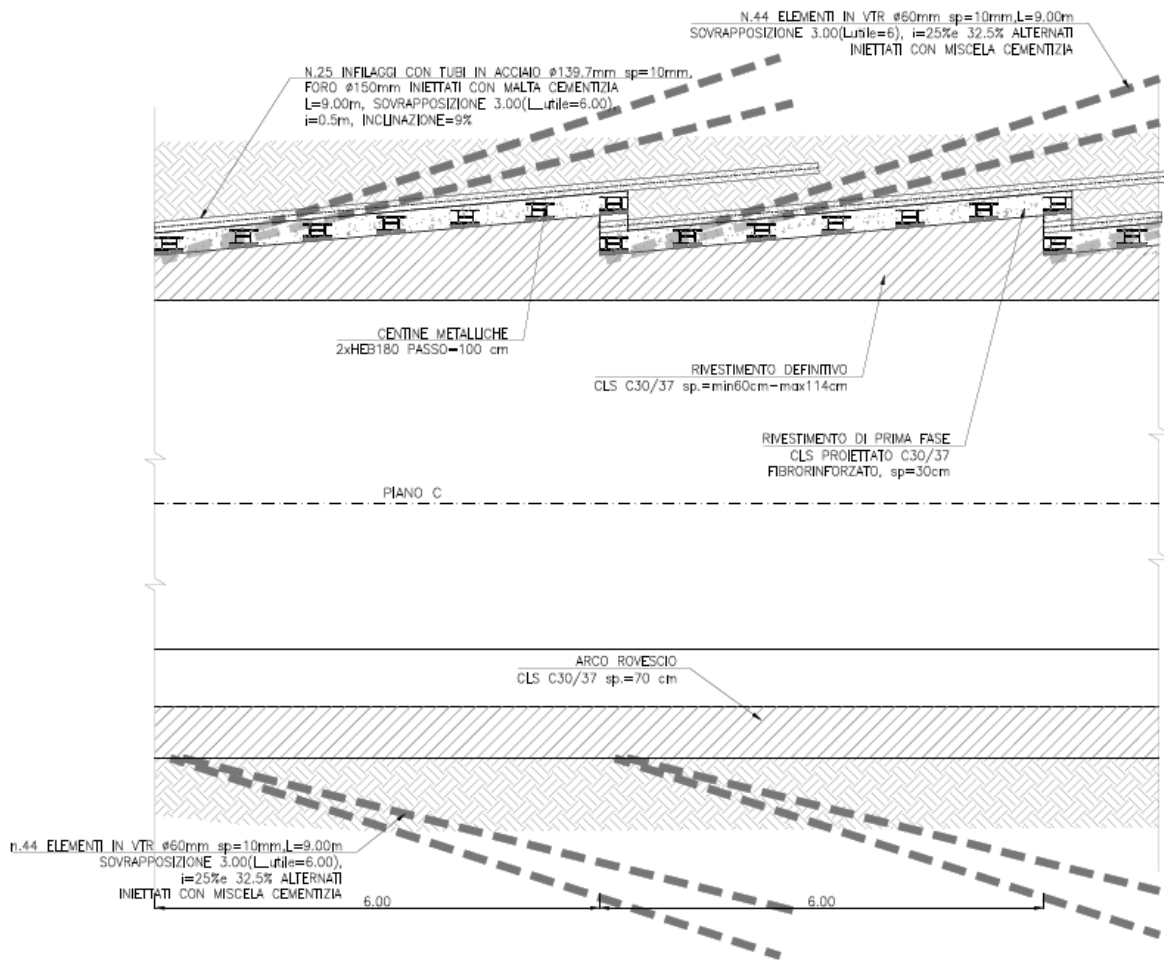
Sezione tipo GI-5: geometria del cavo e interventi di sostegno, sezione longitudinale
